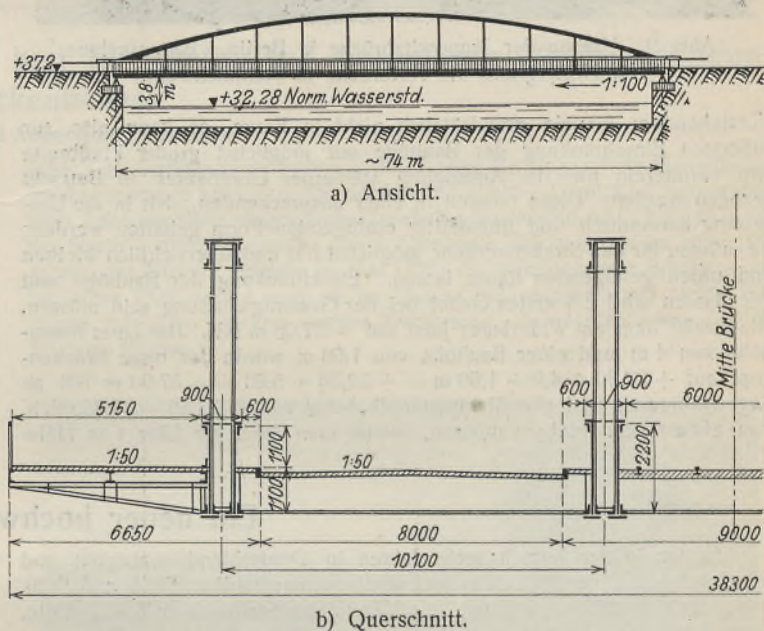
u. b. Vorschlag für einen Stahlüberbau mit vier Hauptträgern für den Neubau der Jannowitzbrücke.
